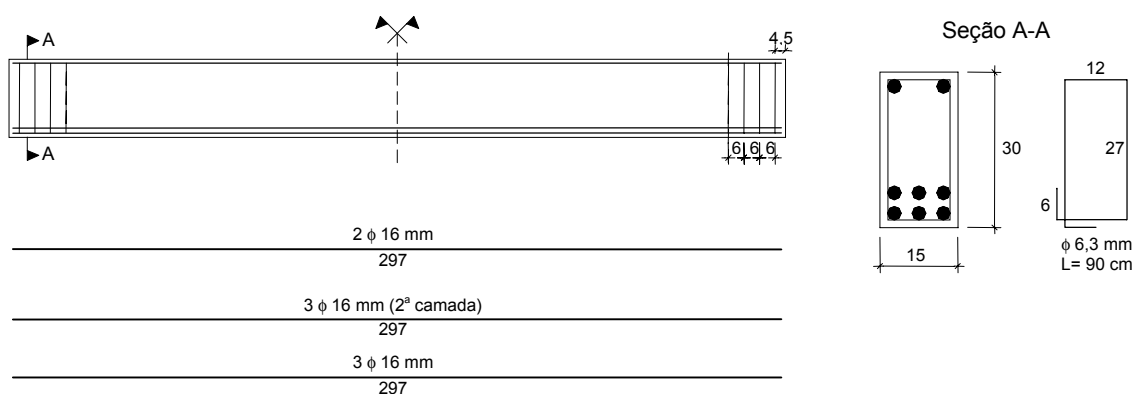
Detalhamento da armadura das vigas do Grupo C
